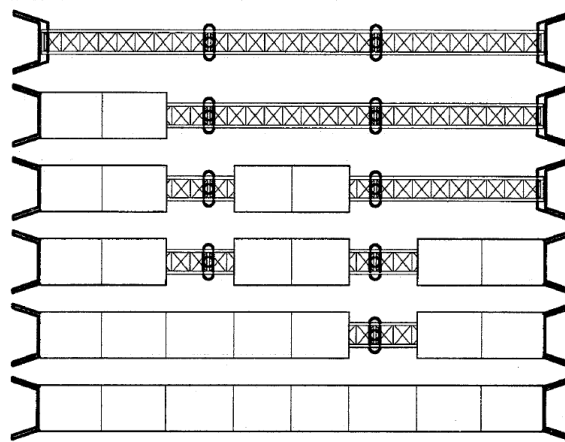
Sequência de betonagem da laje em tabuleiros mistos.(Rosignoli, 2002)
